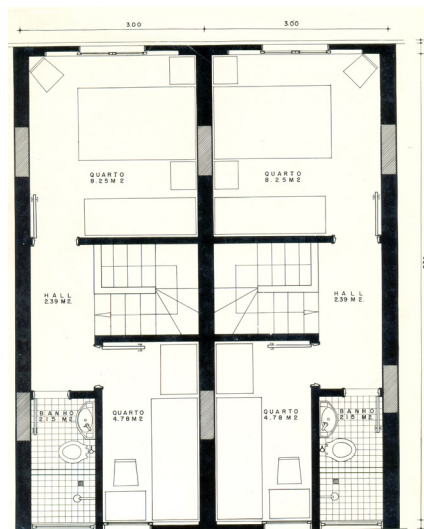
Planta do 2º pavimento do apartamento duplex.
